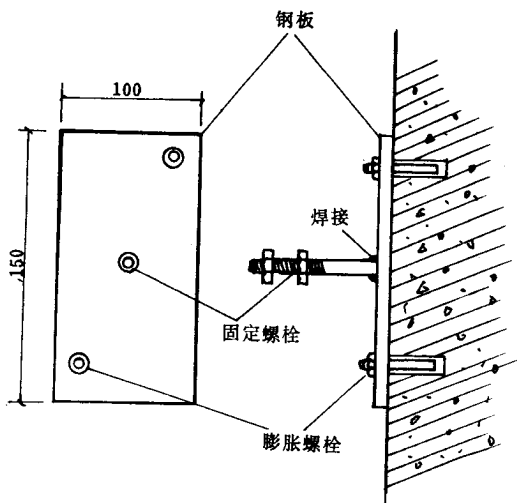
用膨胀螺栓安装在混凝土墙上
